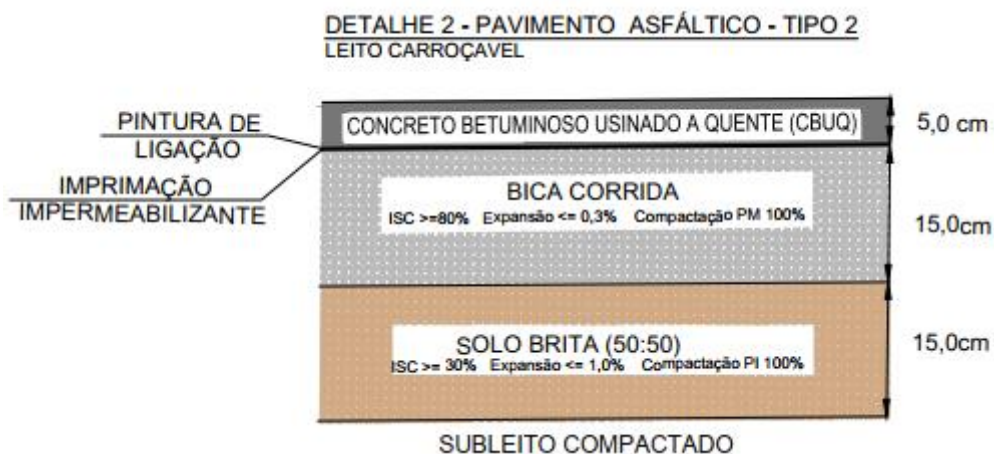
Pavimento Flexível da Via – Tipo 02
